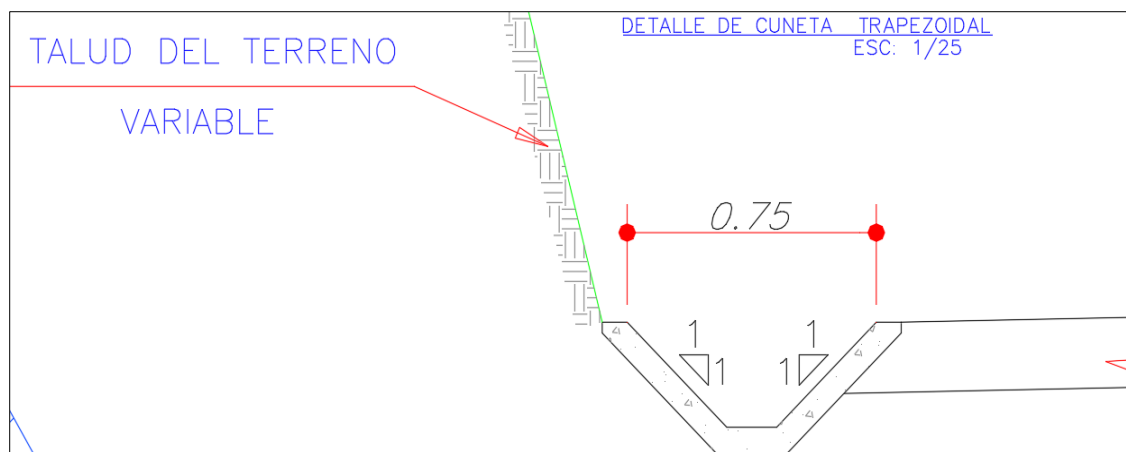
Detalle de la cuneta típica de sección trapezoidal proyectada.
